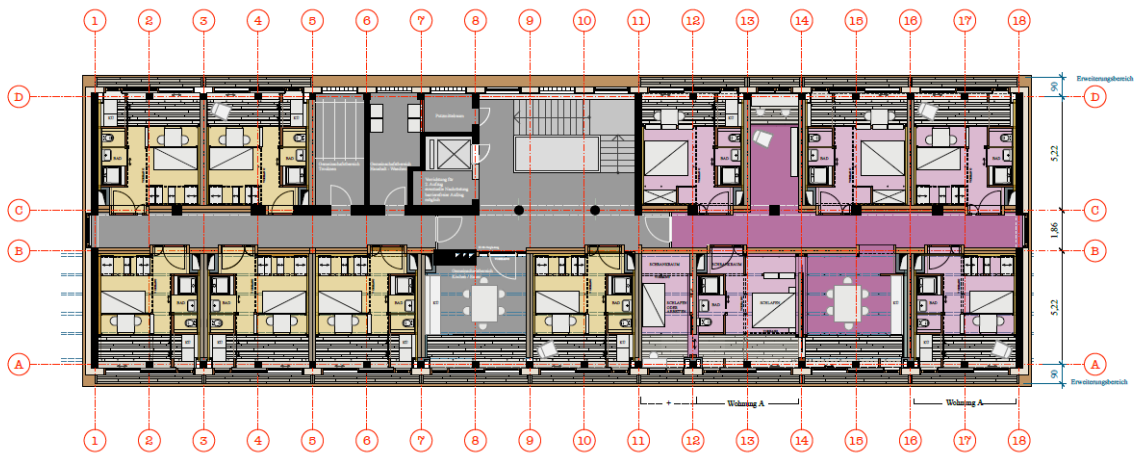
/ Neuplanung Grundriss 1.Obergeschoß
